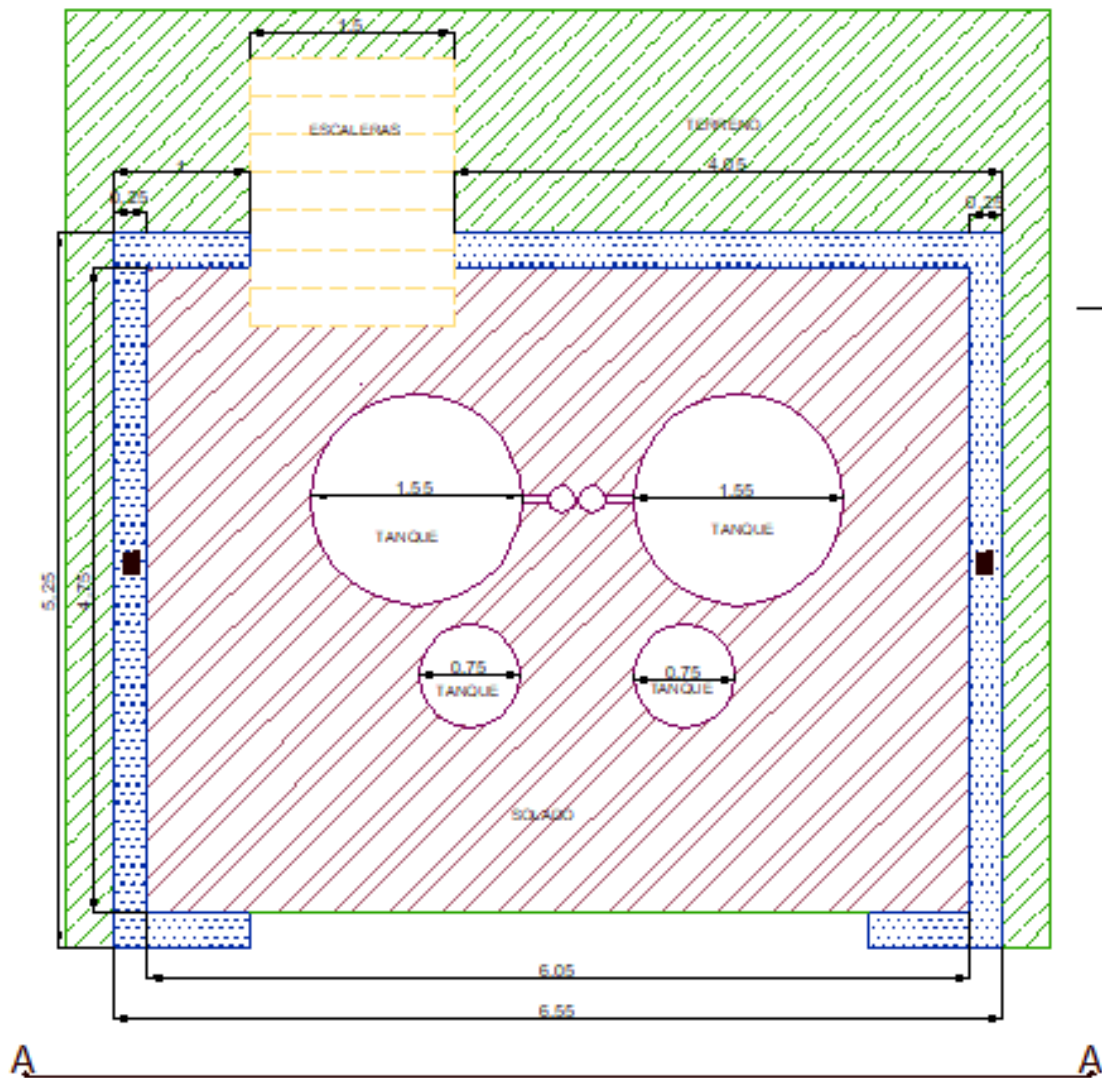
vista en planta de la planta de tratamiento de agua potable en Montecitos.
